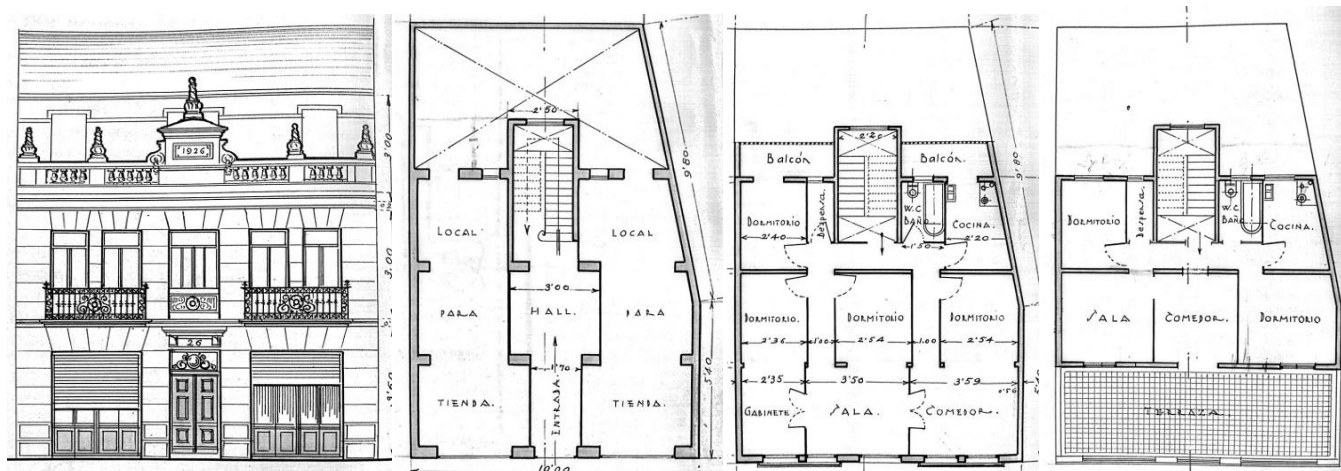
Fachada y planos de las plantas baja, principal y ático del nº 26 de la calle Alcántara. Escala 1:100. AVM, Secretaría, 25-260-6. 1926-1927.
